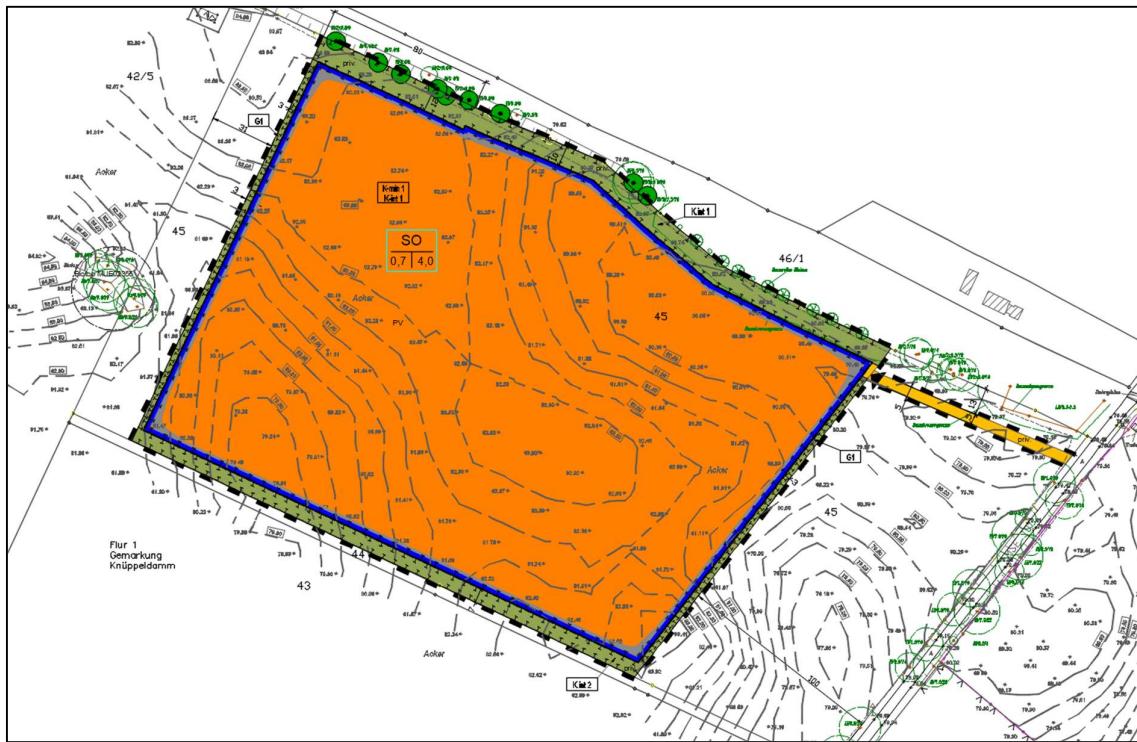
Planausschnitt Planzeichnung Vorhabenfläche Am Bahnhof; Fincken mit Stand 06/2025 (IB PAWLIK 2025 b); orange - SO Sondergebiet für PV-FFA, grün - Grünflächen zum Erhalt sowie Maßnahmenflächen, gelb - Verkehrsflächen
